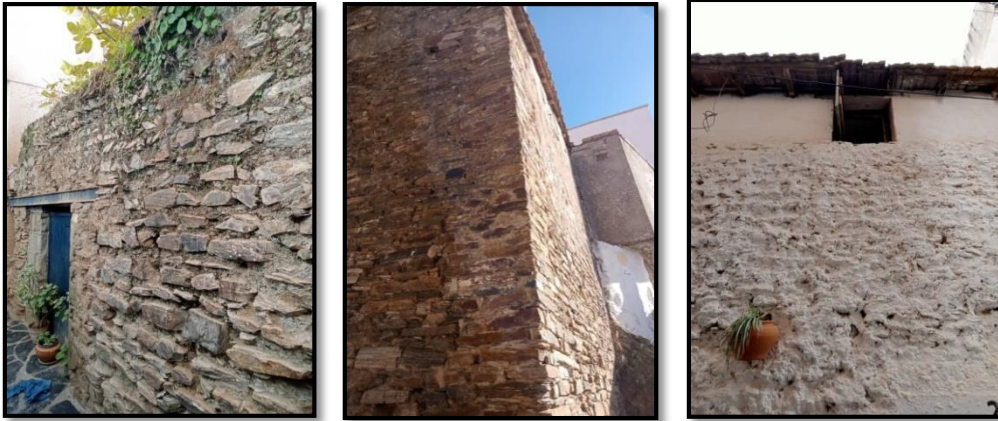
Les anciennes constructions en pierre au village Ath Lahcen
